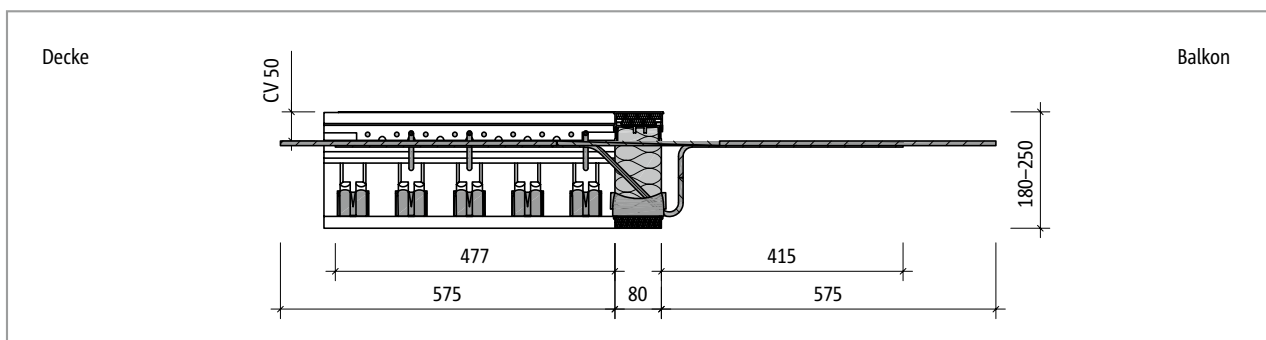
Schöck Isokorb® T Typ C-M1: Produktschnitt
